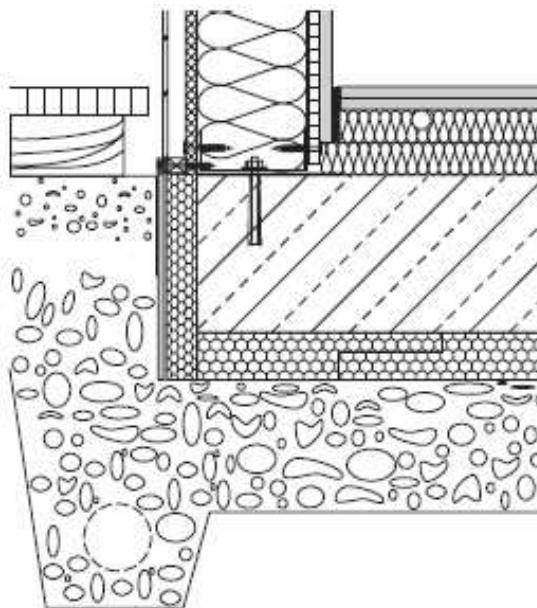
Наружная стеновая, смонтированная на плиту фундамента мелкого заложения
